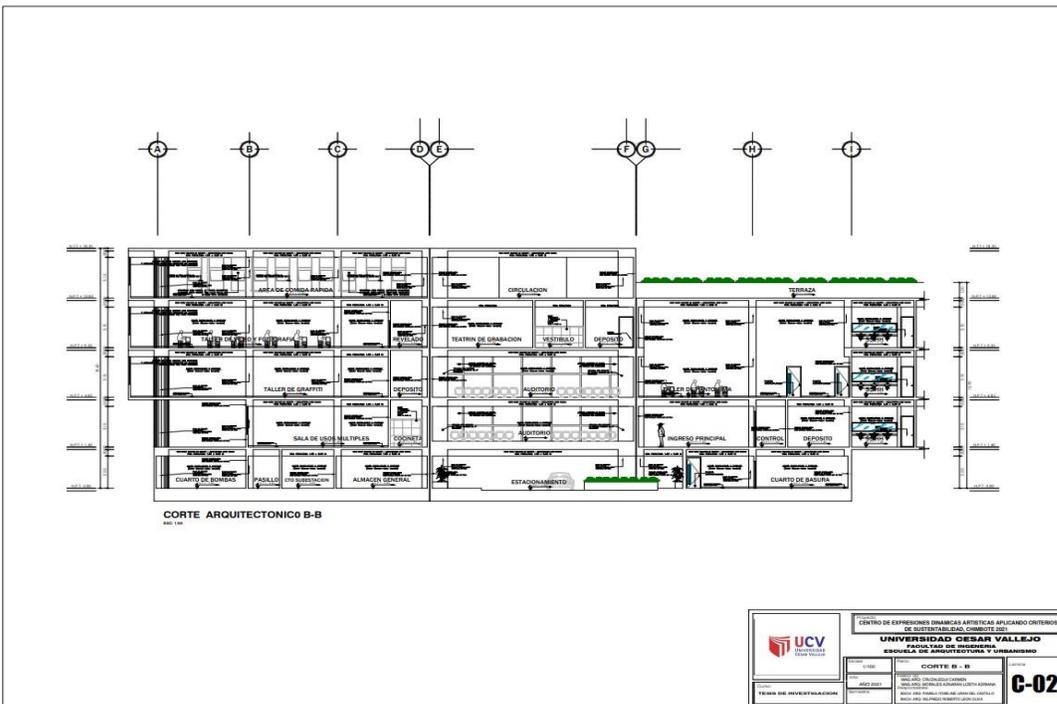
Plano de Corte B-B Detalles. Fuente: Elaboración Propia
